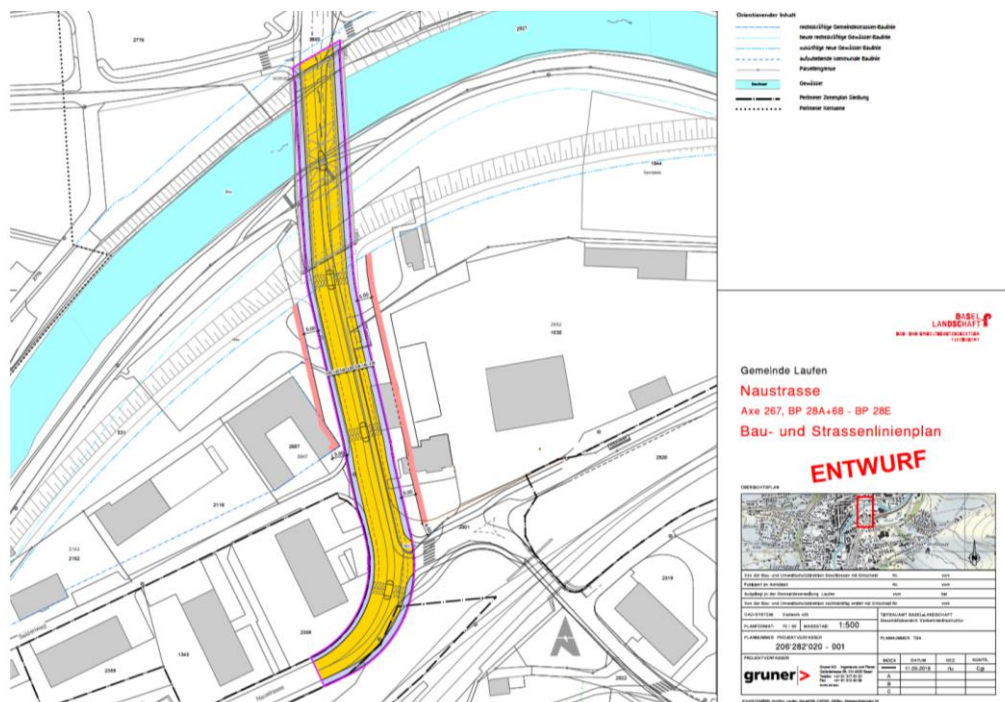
; Naustrasse, Bau- und Strassenlinienplan, Stand 11.09.2018; Quelle: Tiefbauamt Kanton Basel-Landschaft, mit bisheriger Bebauung.
